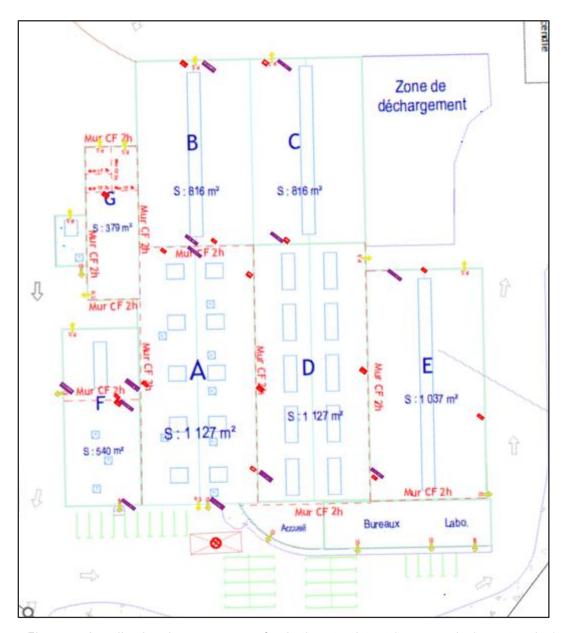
Localisation des murs coupe-feu bâtiment existant (source : sicabconstruction)
